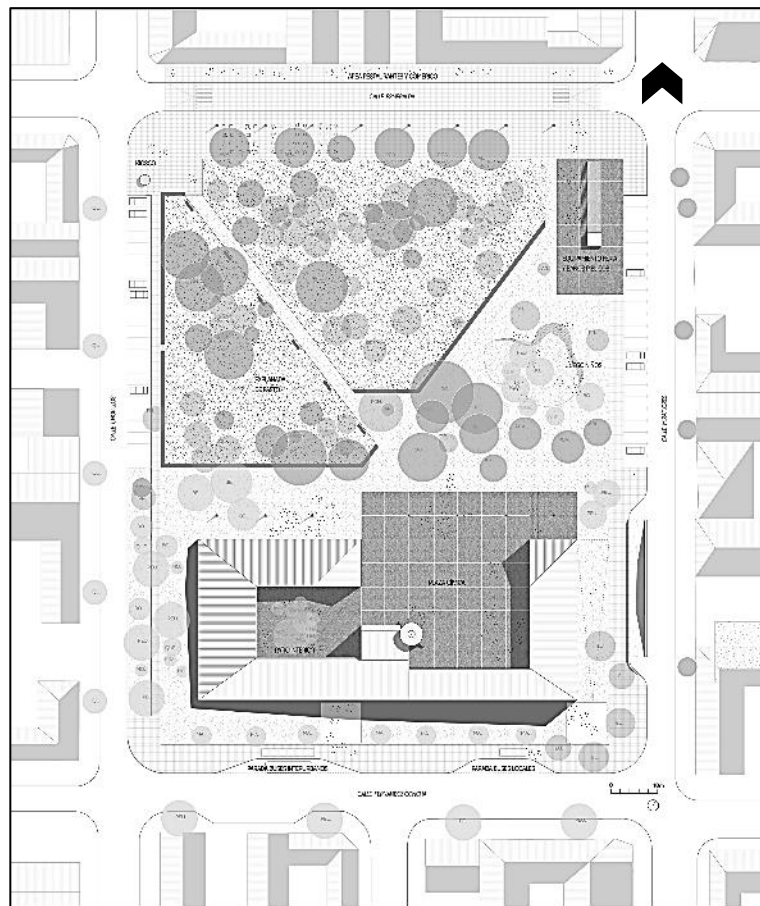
Planta de Emplazamiento del Edificio Consistorial de Papudo
